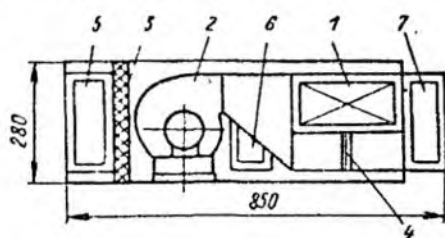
Квартирный отопительно-вентиляционный агрегат
